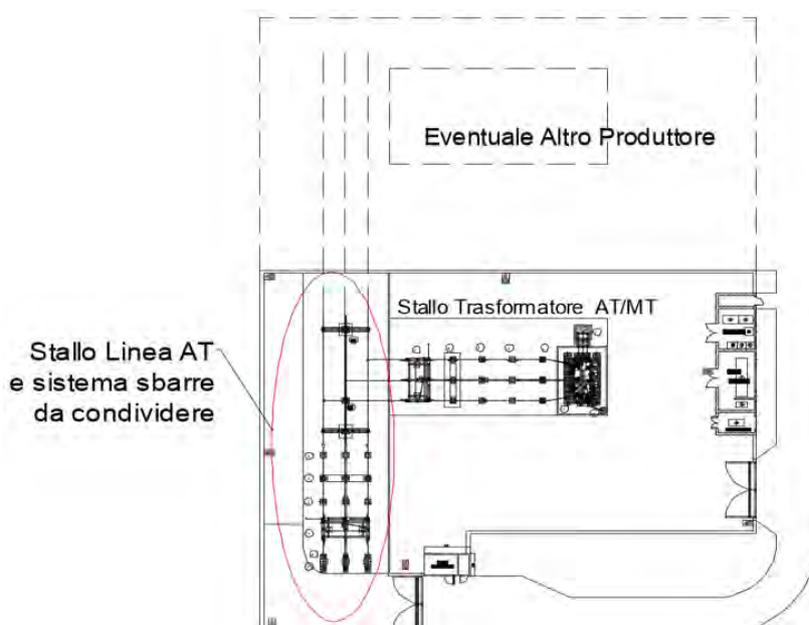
Planimetria Sottostazione di Trasformazione Utente AT/MT
